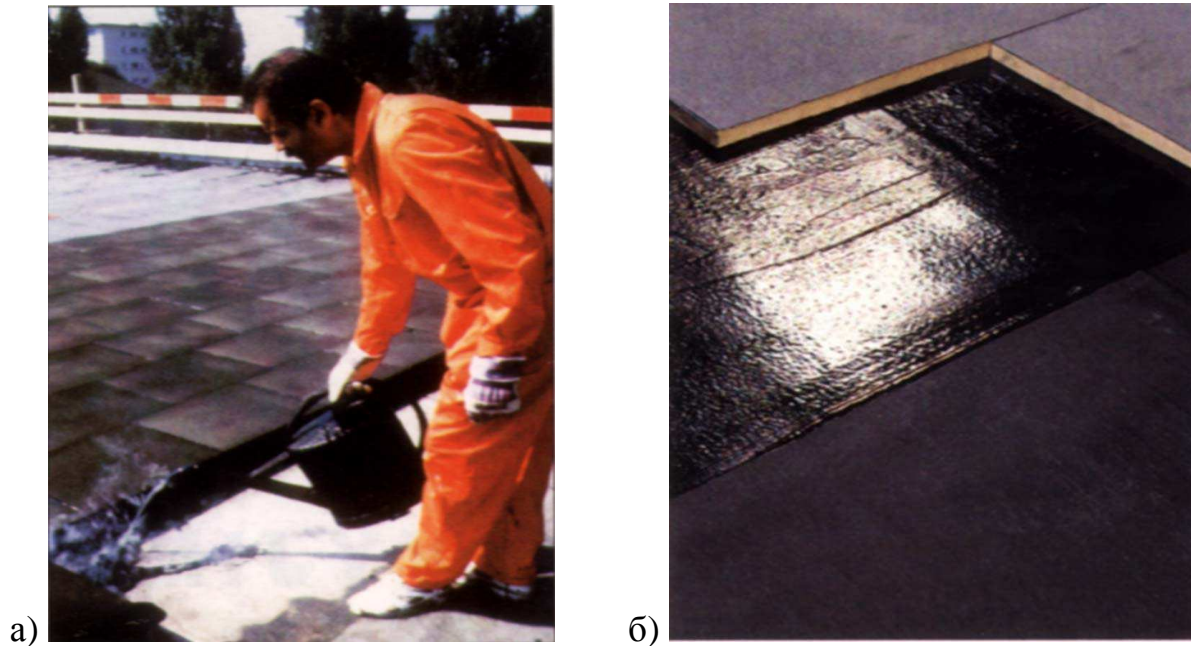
Укладання жорстких плит на основу із залізобетонних плит із приклеюванням мастикою:
